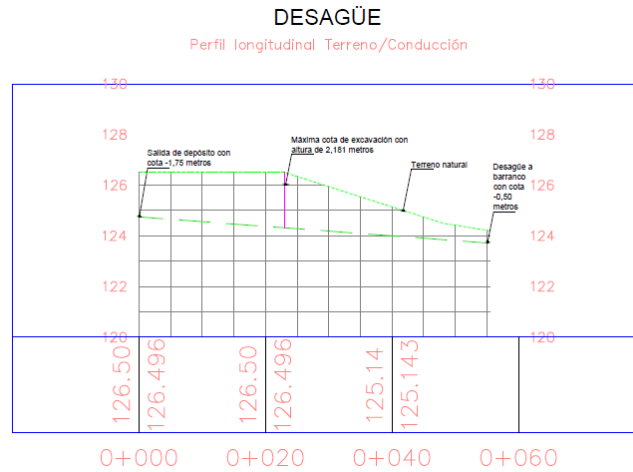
Figura IV. Perfil Longitudinal de Conducción de Desagüe
